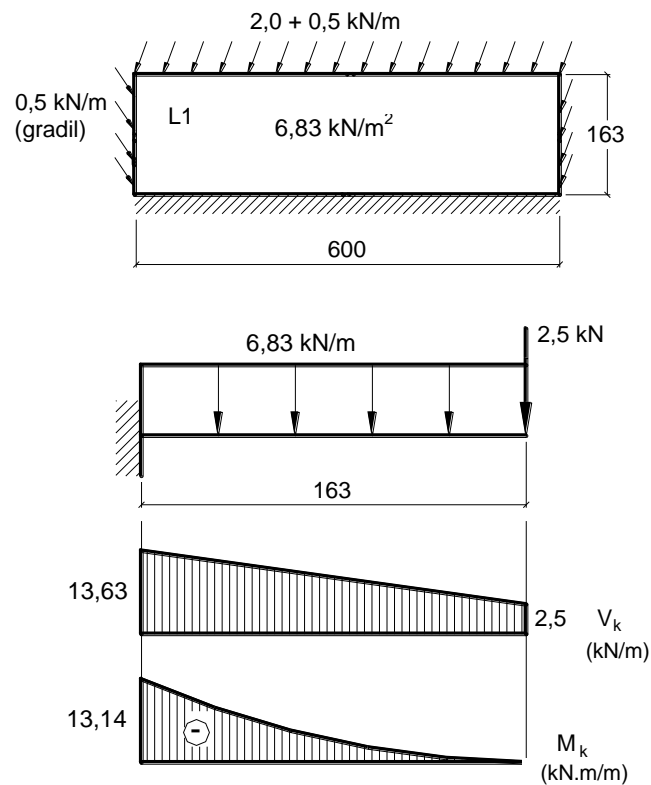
Esquema estático, carregamentos e esforços solicitantes característicos na laje L1, por metro de largura de laje.
